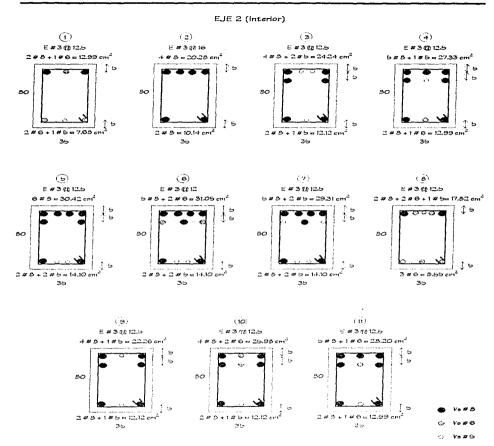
Tipos de armados de vigas del eje 2, edificio de 7 niveles diseñado en la zona III
